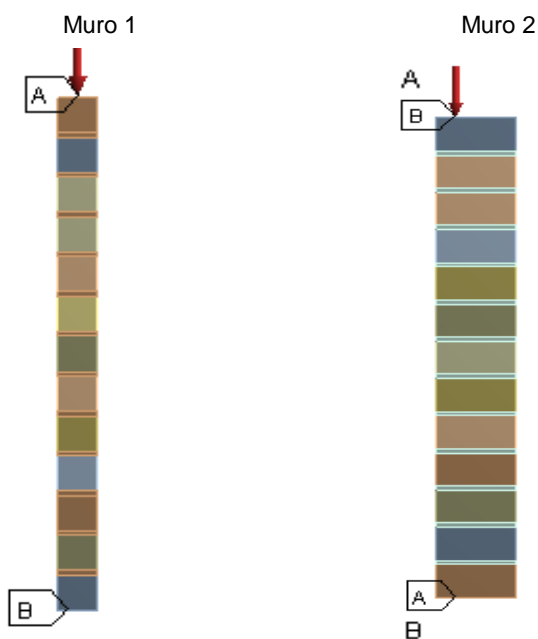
Resumen del modelado del muro sin refuerzo: Empotrado en la zona B. La carga distribuida sobre el espesor del muro actúa en la zona A
